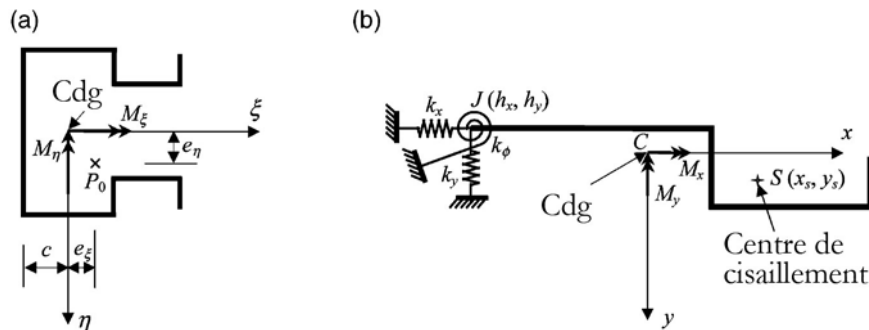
Semelle élastiquement appuyée sur la jonction âme – semelle : (a) section de la colonne étudiée ; (b) semelle isolée.
